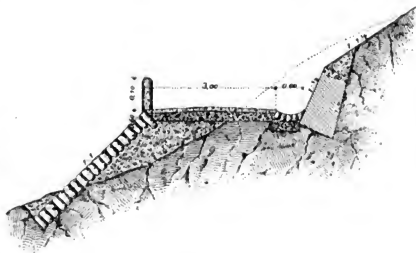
Straße im Kanton Graubünden. M. 1:100.
